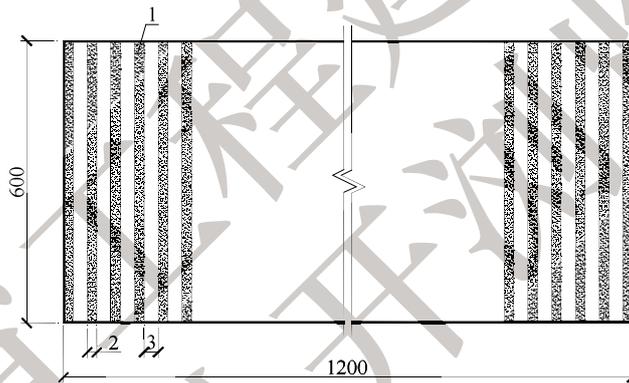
条粘法示意 (尺寸单位: mm)
